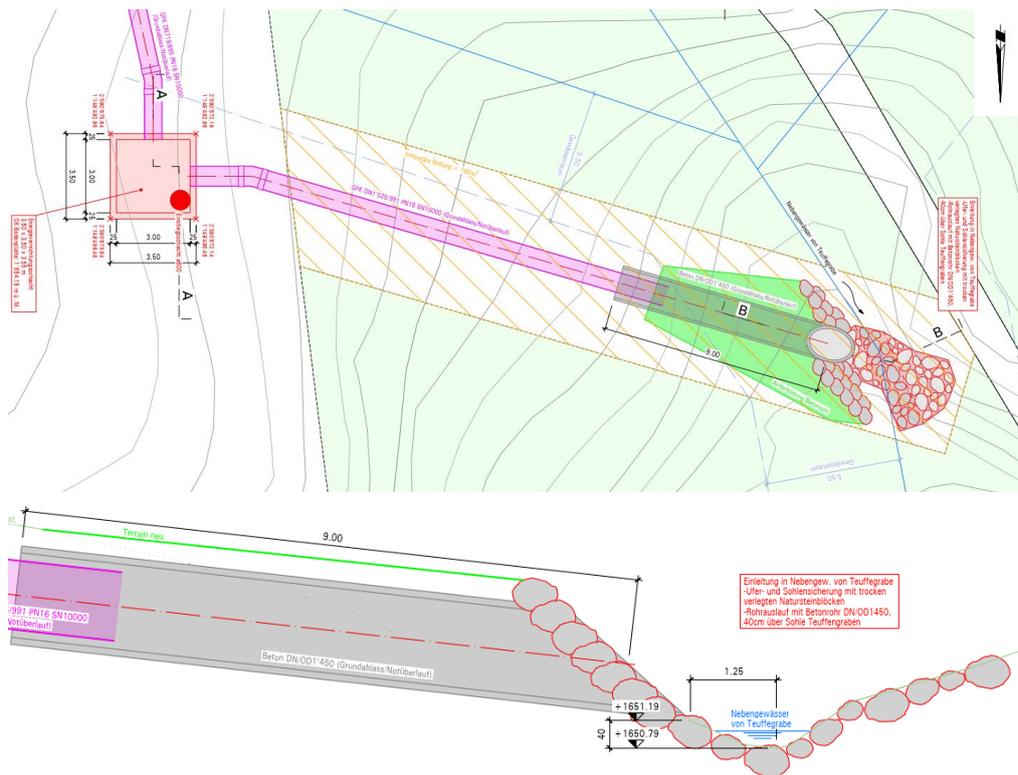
Ableitung Grundablass/Notüberlauf inkl. Einleitstelle und Gewässerquerungen gemäss Bauprojekt Situationsplan und Profile (Quelle: Steiger Ingenieure + Planer AG)
